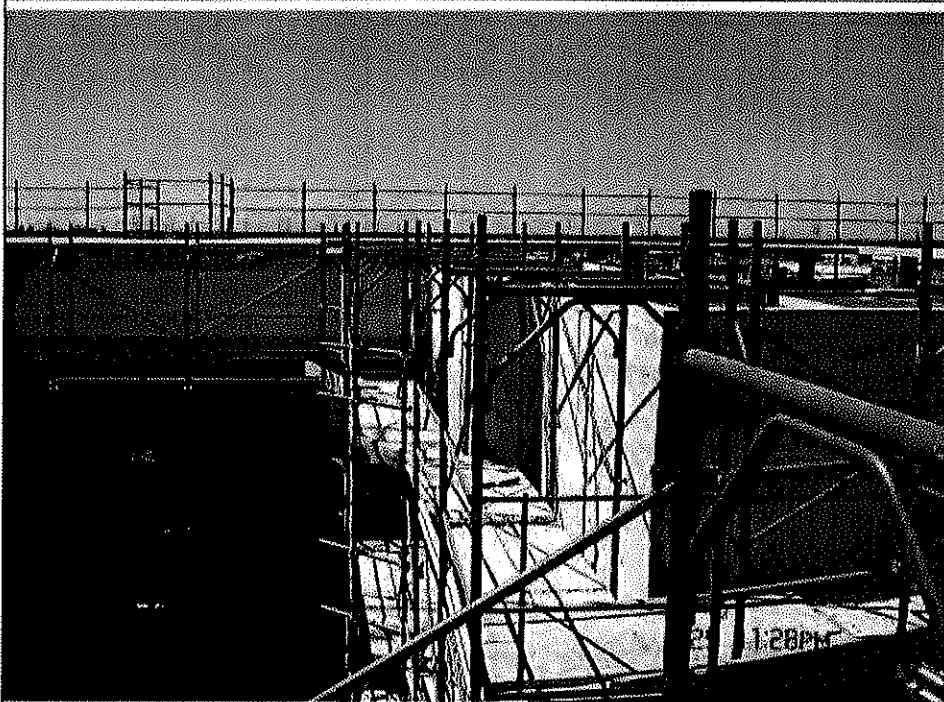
Corpo di fabbrica dell'hotel. Vista interna.
